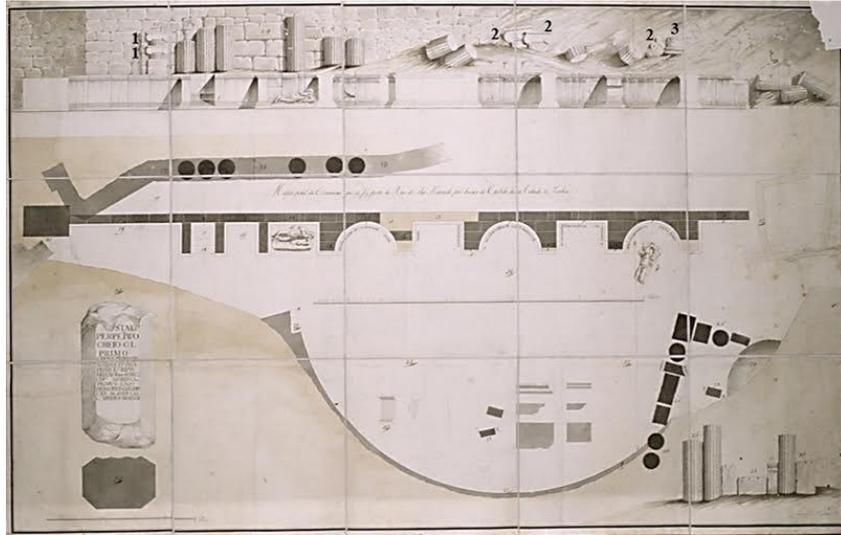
Planta e atuais instalações do Museu Teatro Romano.
